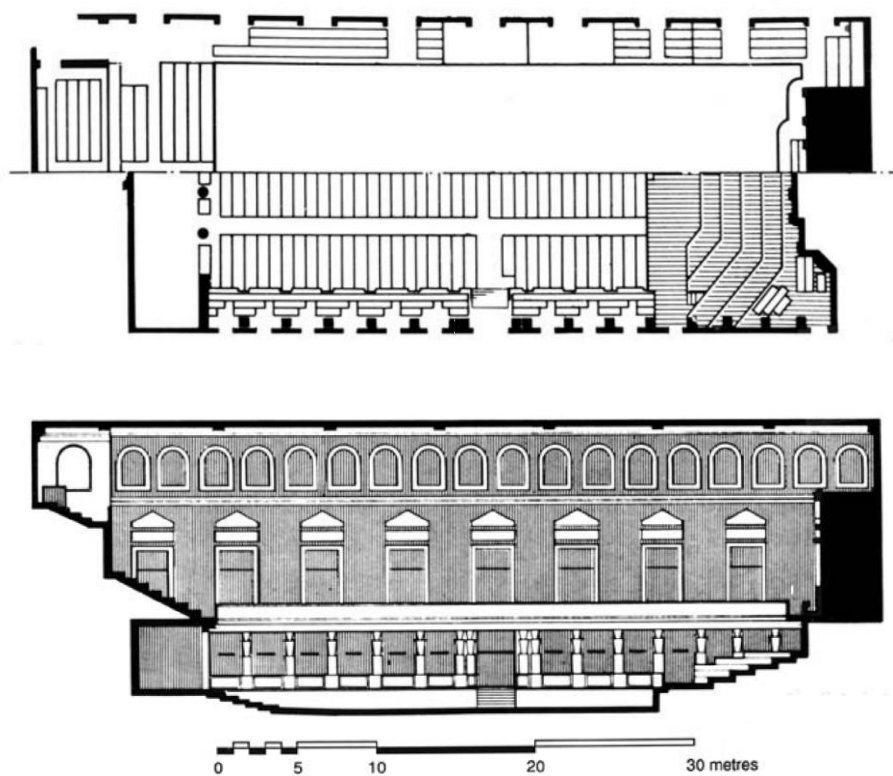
Musikvereinsaal, Viena. Planta e corte (Barron, 2009)
